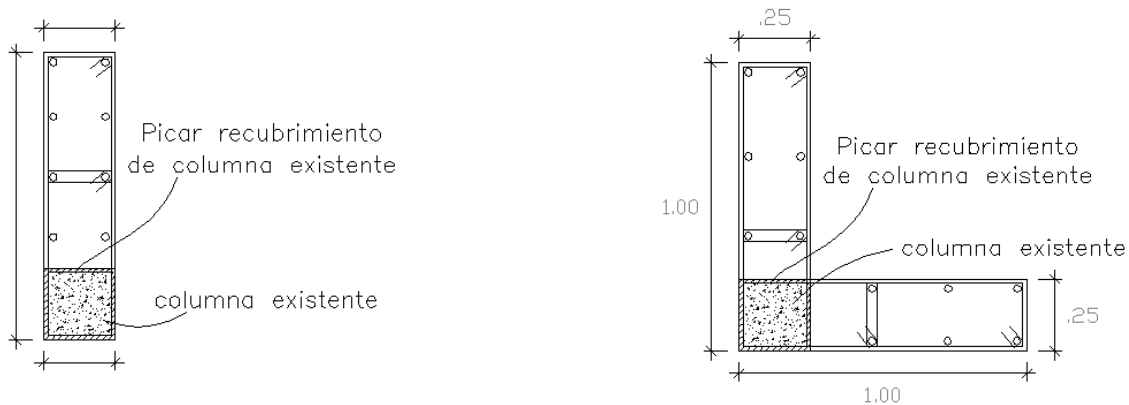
Detalle de reforzamiento para columna existente y esquinera
